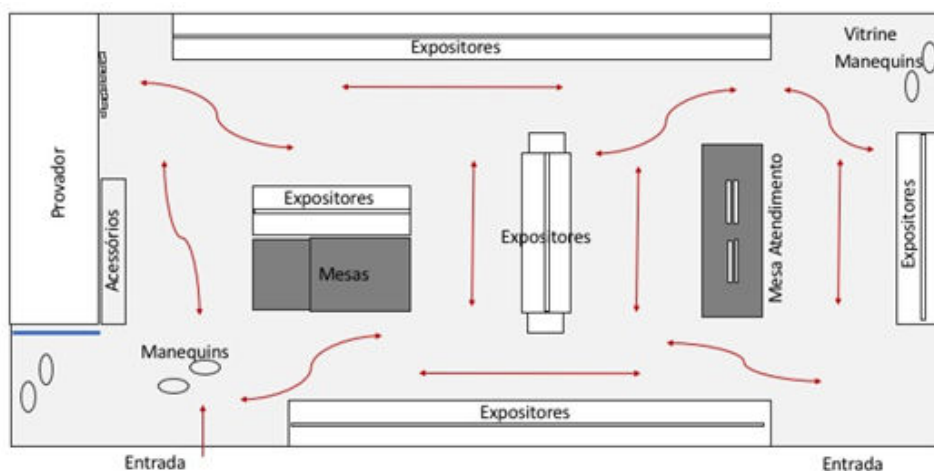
Planta sem escala de layout da *Guideshop* Amaro Vila Butantã – São Paulo. Projeto esquemático.
